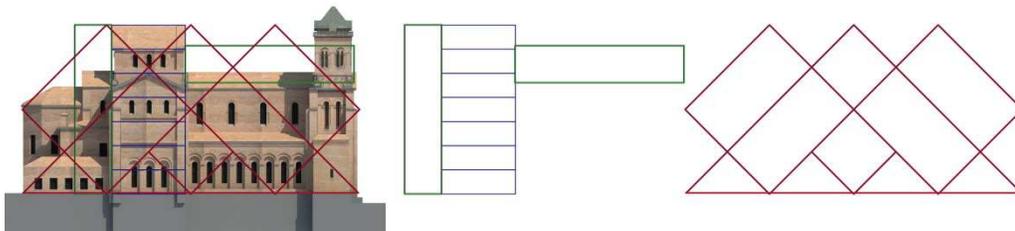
Geometría euclidiana encontrada en las fachadas laterales
